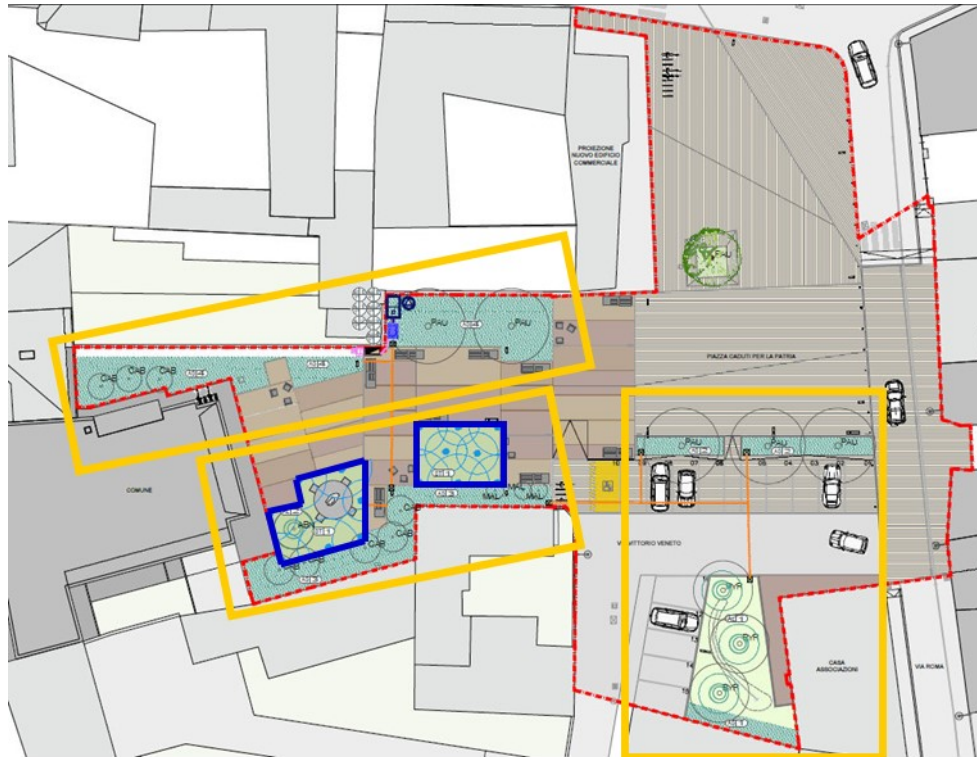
Schema dell'impianto di irrigazione - estratto Tav. V07 – Impianto di irrigazione
